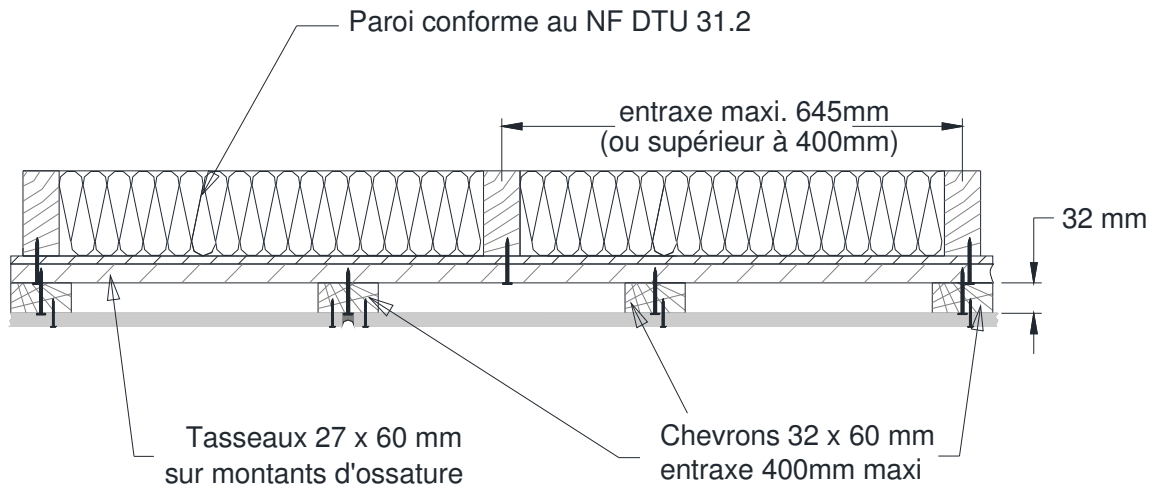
Coupe horizontale sur COB – Pose horizontale (entraxe > 400 mm) – Pose sur double chevronnage
